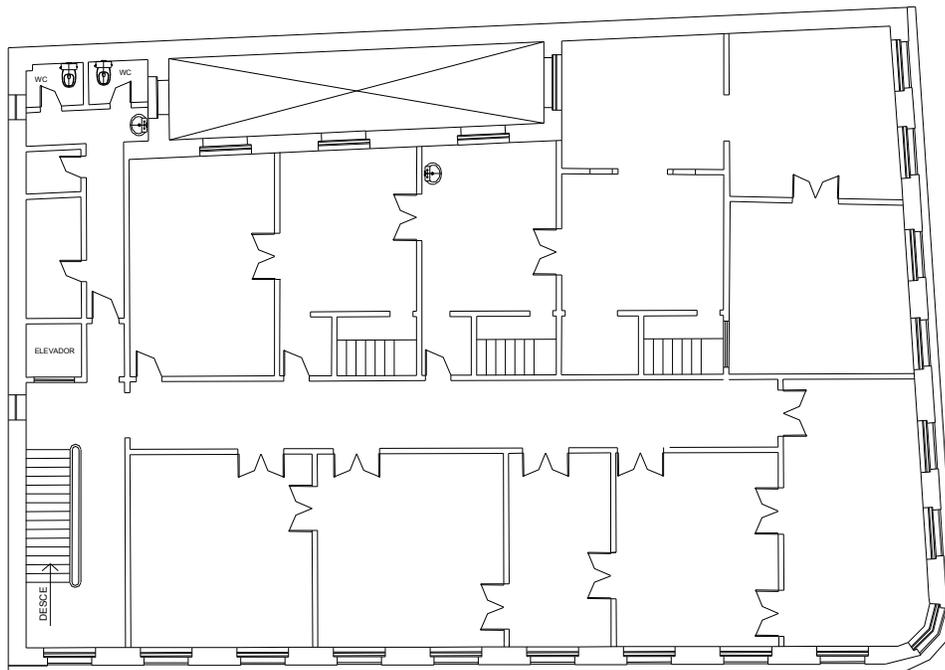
Situação atual no primeiro pavimento do imóvel da Trav. Leão XIII, N° 55/Rua Santo Antônio 139/153, onde as salas estão parcialmente ocupadas.
